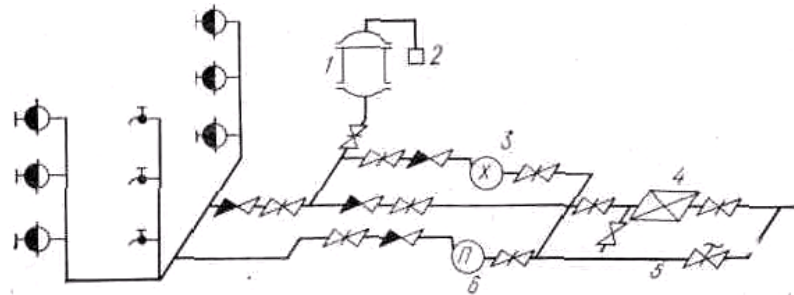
Схема водопроводу з водонапірним баком і насосами
